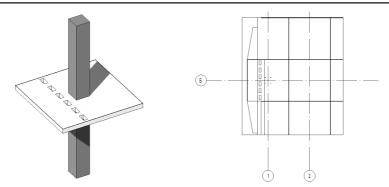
Фрагмент плана межэтажного перекрытия
